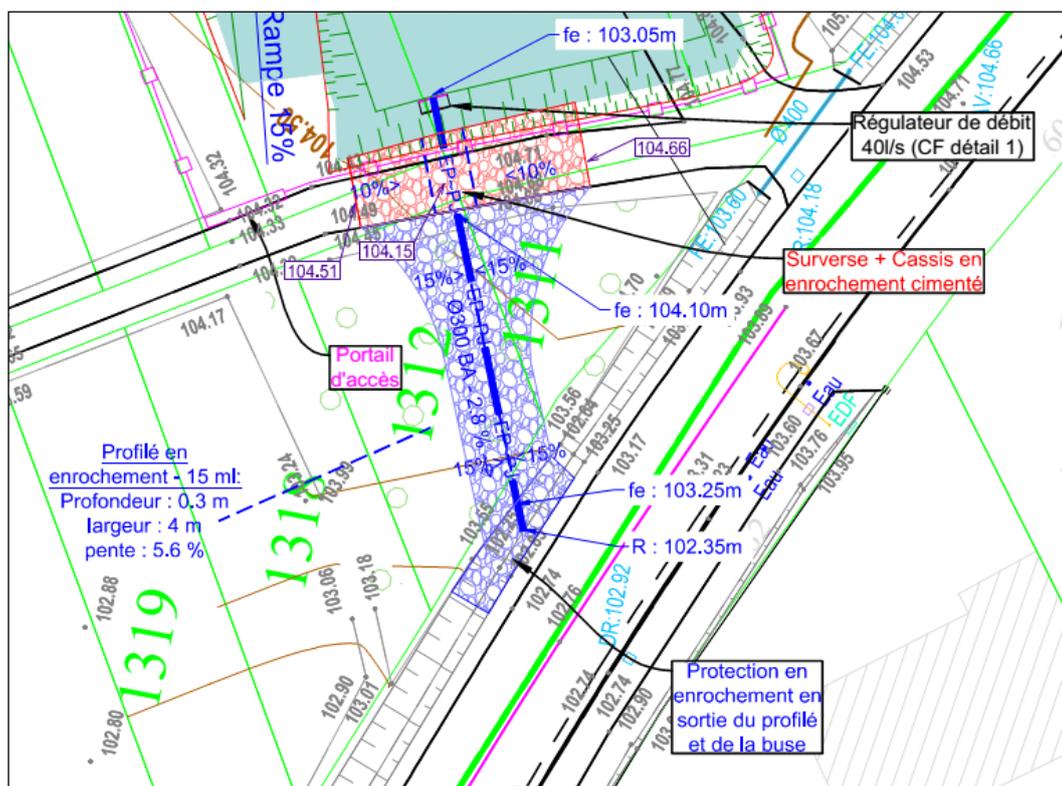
Extrait du plan de masse - Vue en plan de l'organe de vidange de l'ouvrage n°002
